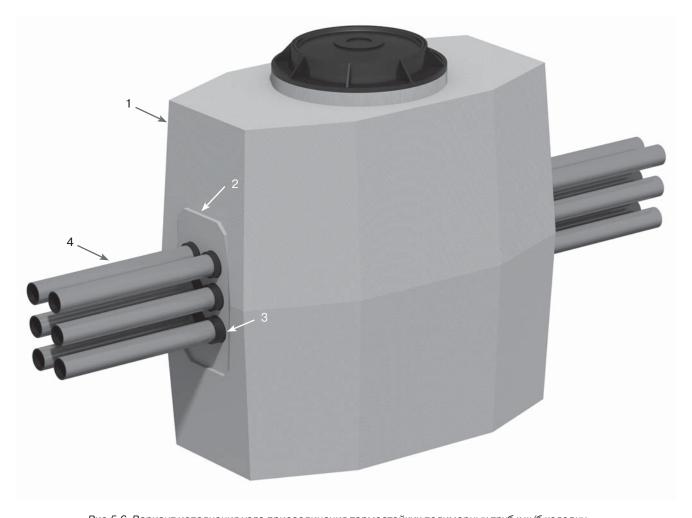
Вариант исполнения узла присоединения термостойких полимерных труб к ж/б колодцу с использованием защитных муфт для прохода полимерных трубопроводов через стенку бетонного колодца
